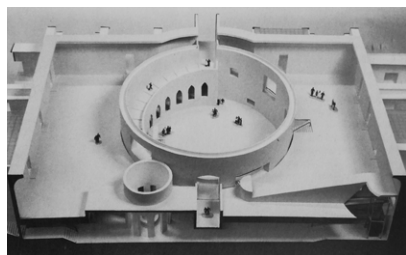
Detalle de maqueta seccionada. Propuesta de Stirling y Wilford.
